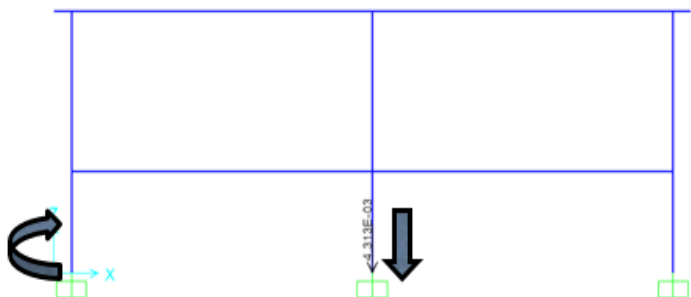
Marco de concreto de 2D de la Pila 1 con el asentamiento de la columna central en conjunto con la rotación del cimiento izquierdo. Fuente: Elaboración propia.
